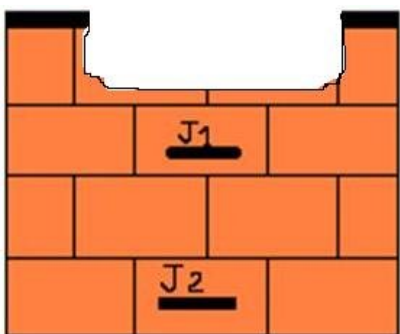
Mécanisme de rupture mur essai n°10.
